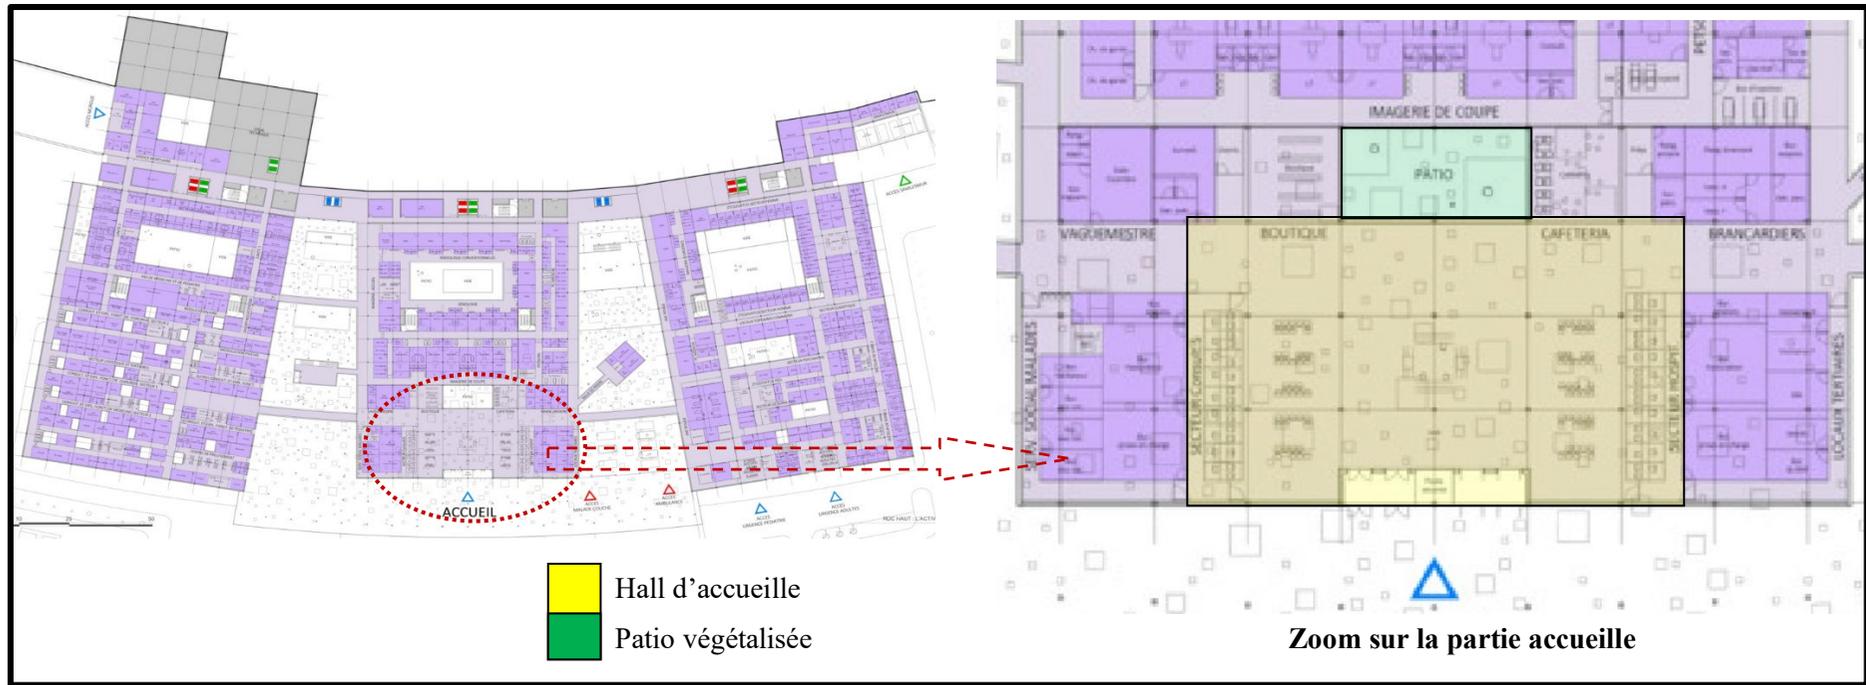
plan REZ-DE CHAUSSEE CHU DE TANGER⁷²
